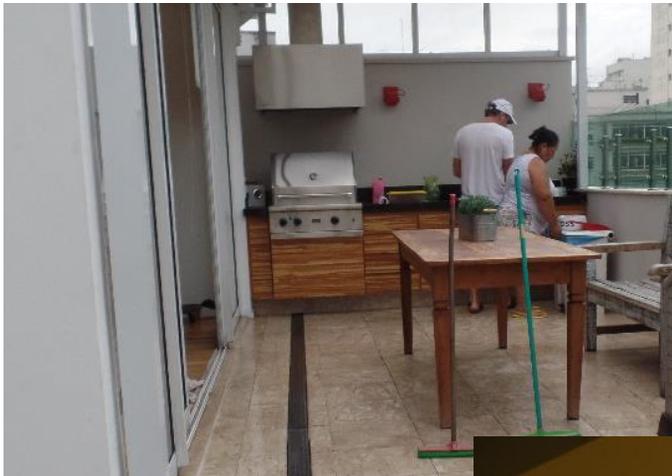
Terraço reformado sobre o apartamento da foto abaixo que apresenta falhas no sistema de impermeabilização e/ou coleta de águas pluviais (matéria sendo discutida na justiça).
